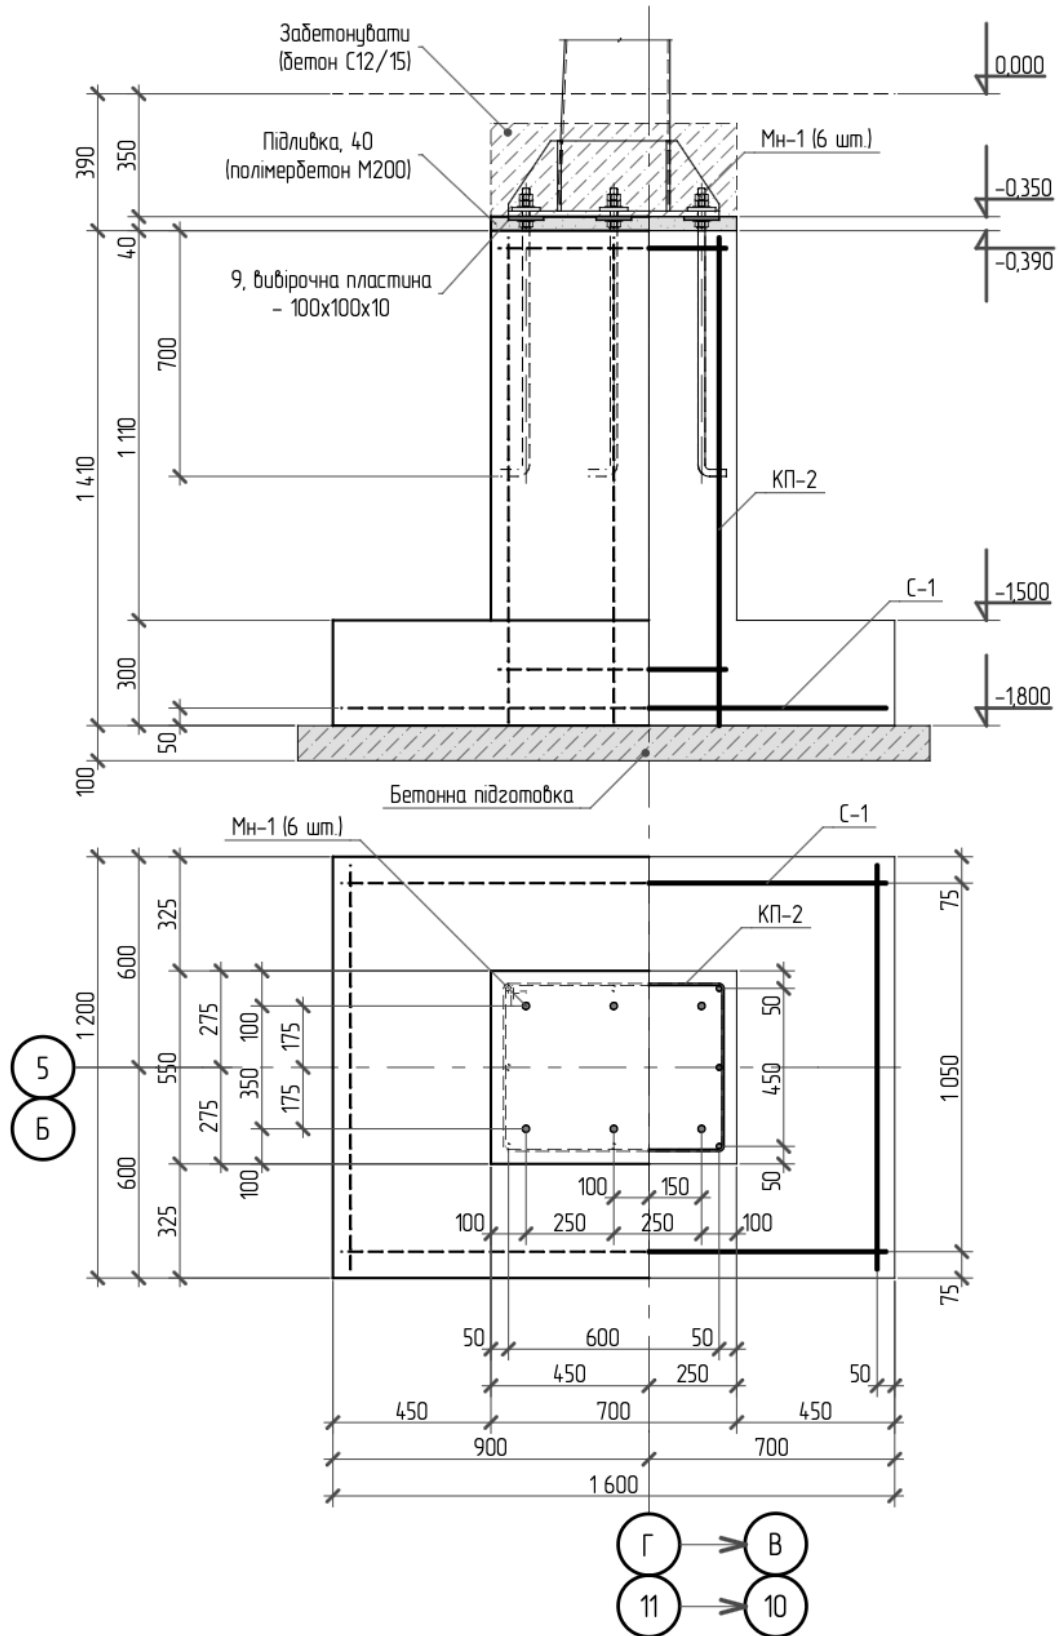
Вузол влаштування фундаменту ФМ-3
